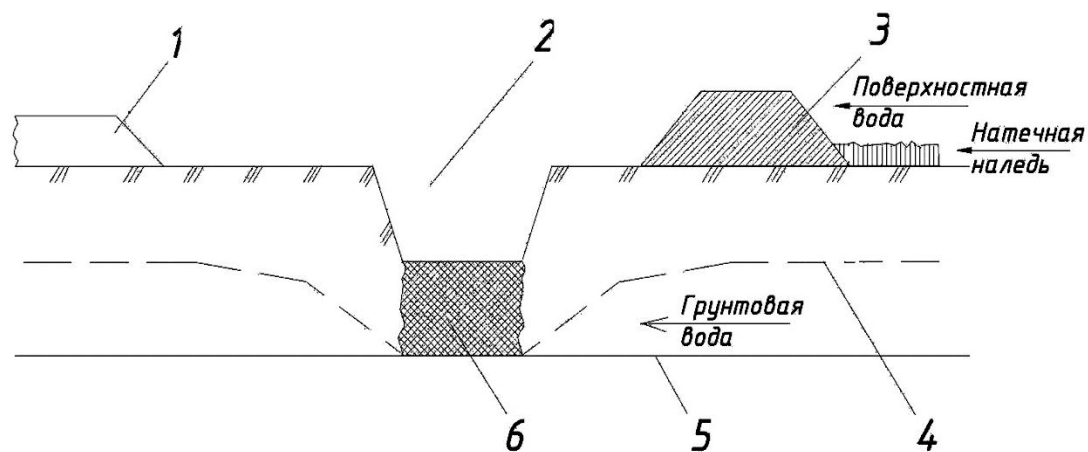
Устройство мерзлотного пояса: 1 – дорога; 2 – канава; 3 – грунтовый вал; 4 – граница зимнего промерзания грунта; 5 – уровень вечного промерзания грунта; 6 – мерзлотный пояс (промерзшая грунтовая перемычка)
